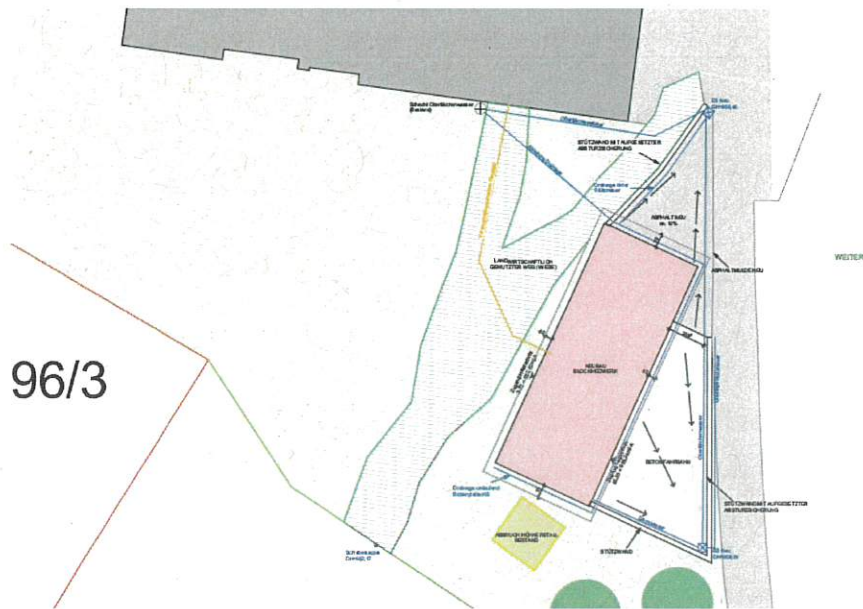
Geplante Lage und Ausführung des Heizwerks
